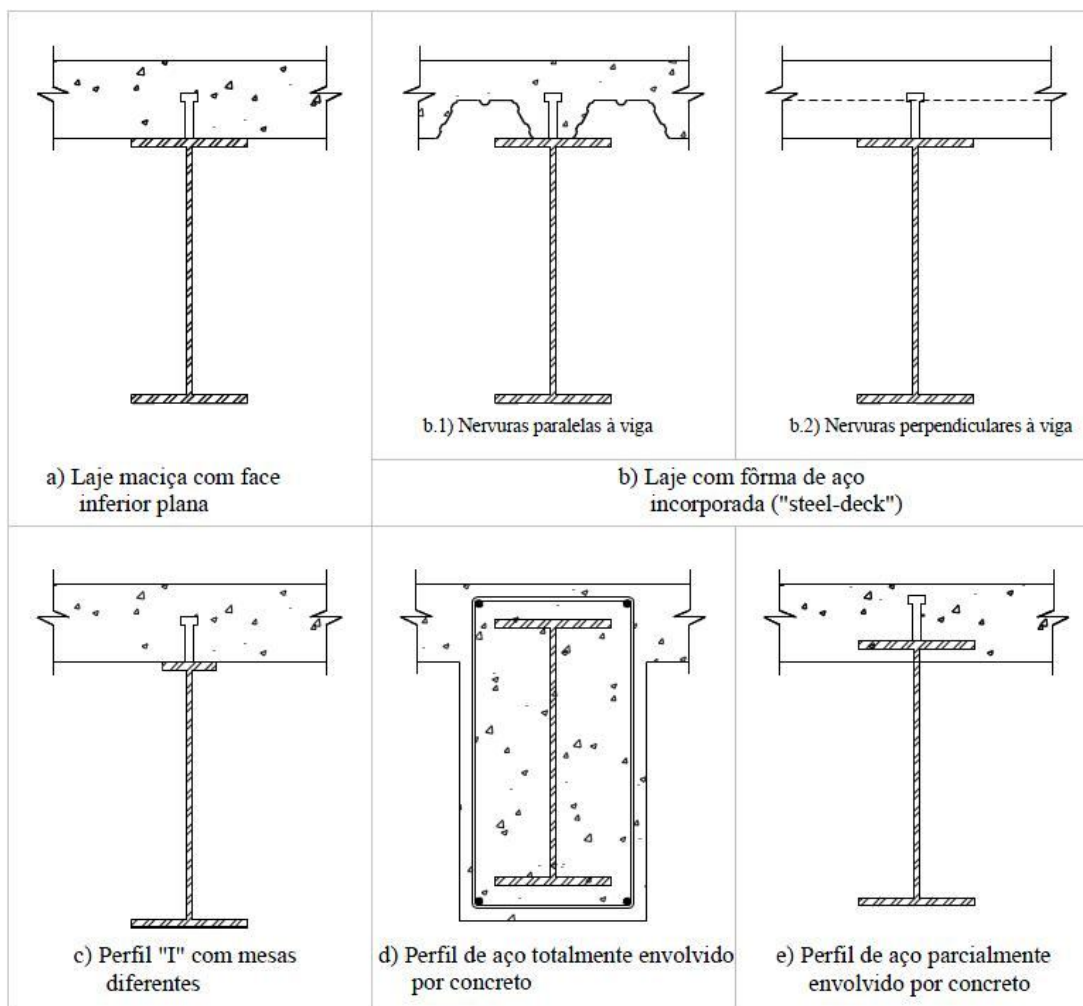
Principais tipos de vigas mistas (FABRIZZI, 2007)
